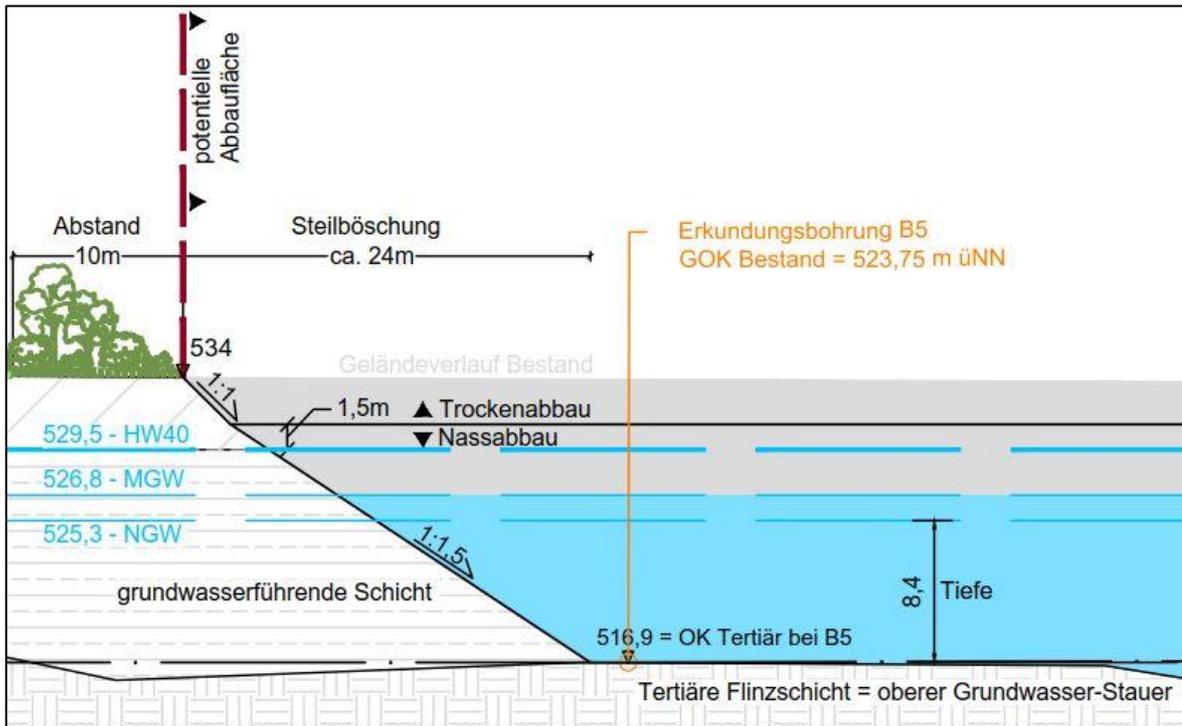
Ausschnitt aus Plan Nr. 06 - Schnitt durch westliche Steilböschung, siehe Planunterlagen
